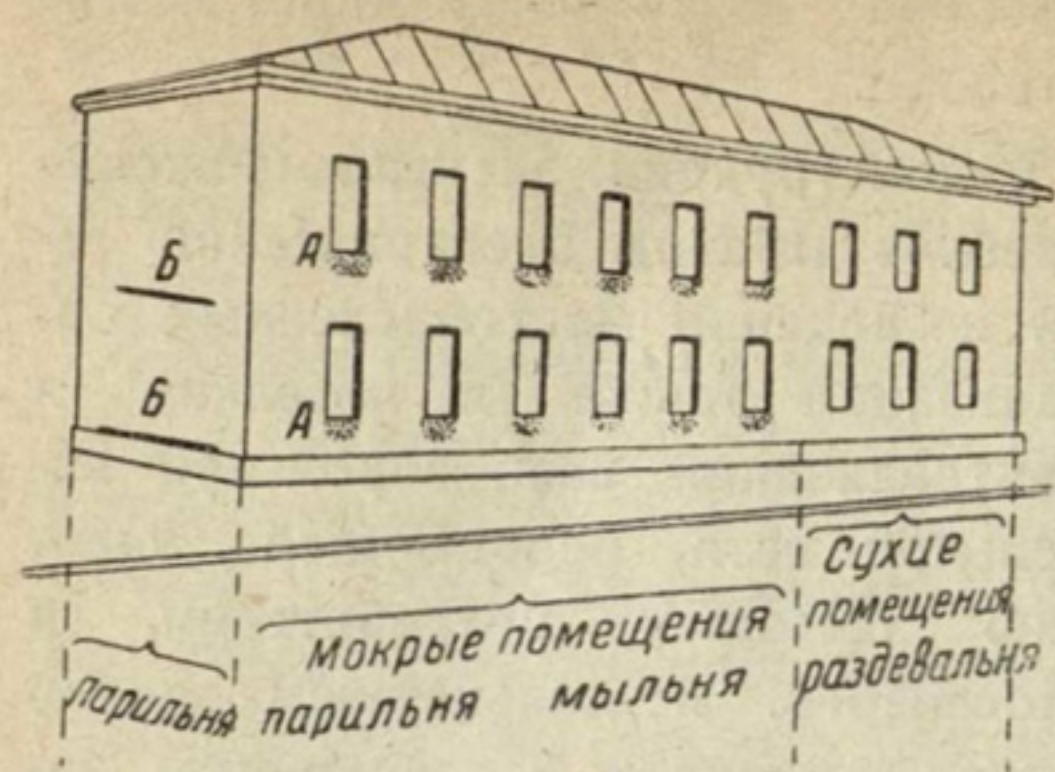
Расположение мокрых пятен на наружных стенах: а) под окнами, б) на уровне перекрытия и цоколя.
